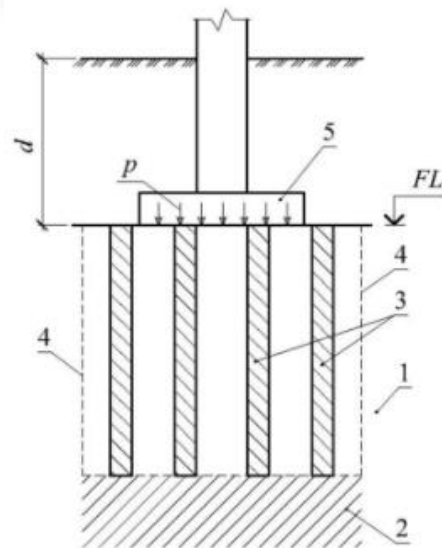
Схема глубинного уплотнения лессовых просадочных грунтов грунтовыми сваями:
